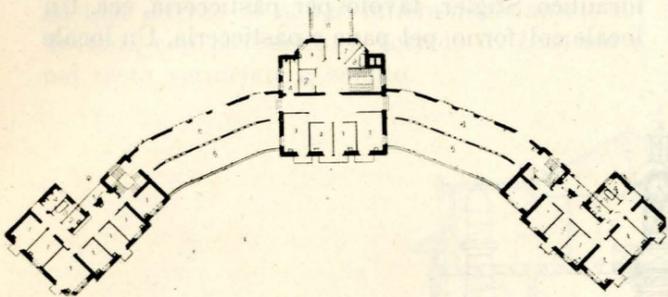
Pianta dell'edificio principale al 2° piano.
